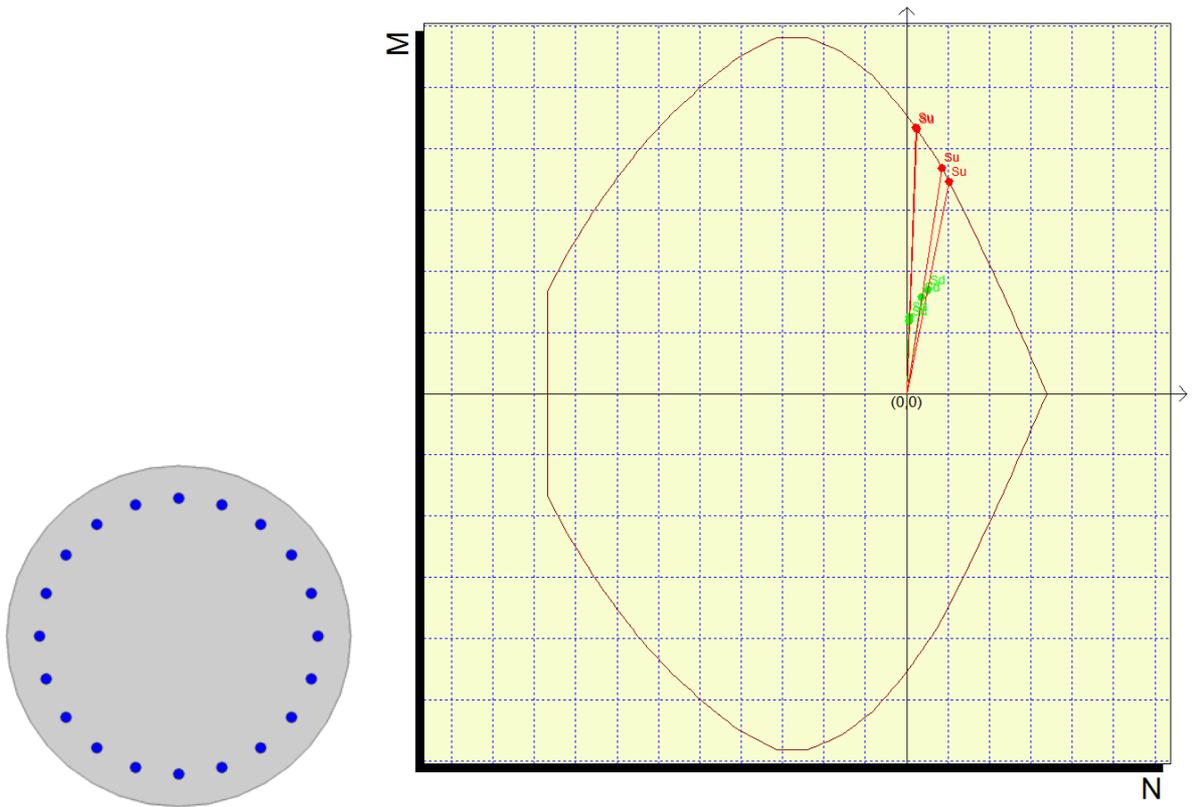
Dominio SLU della sezione di testa dei pali UP4-UP5
